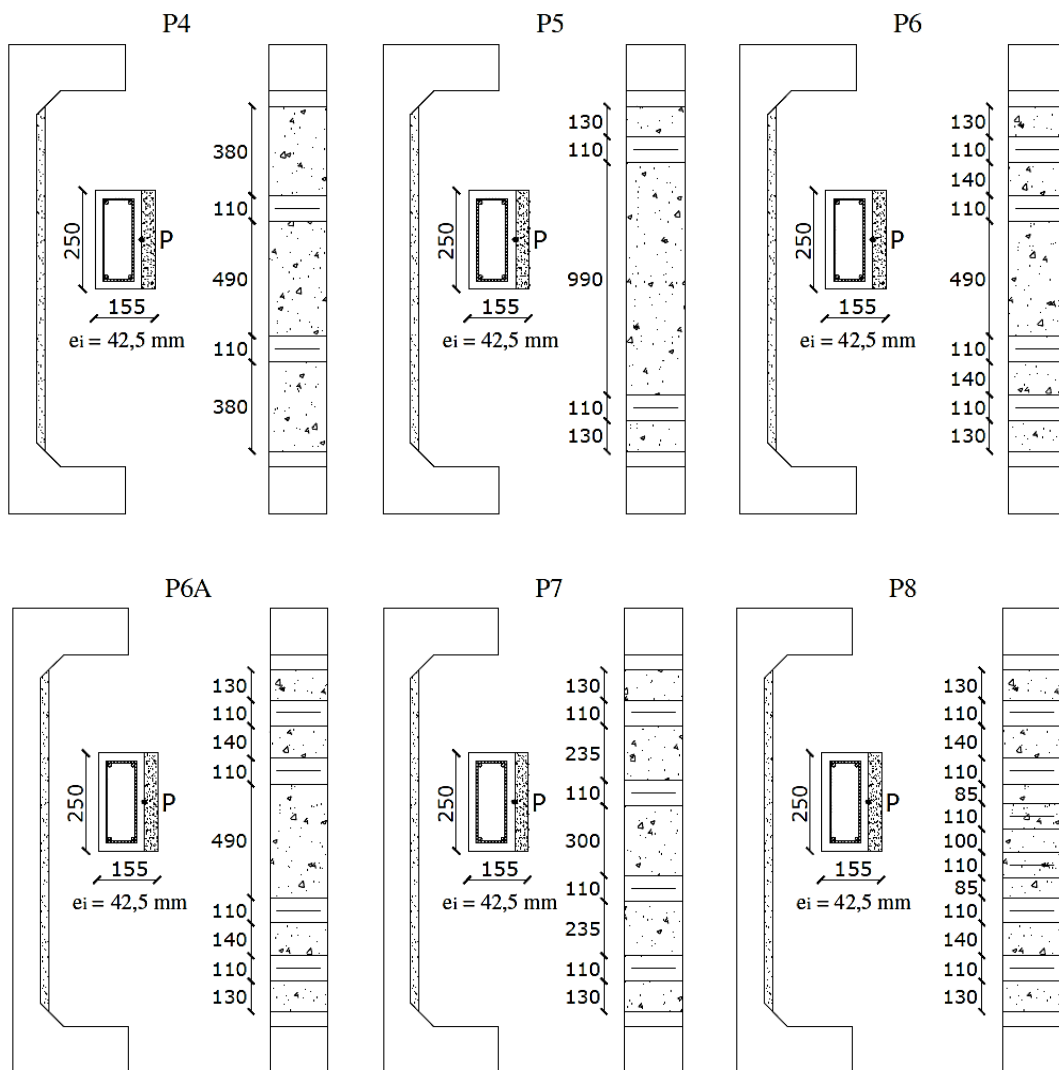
36 - Localização dos estribos conectores na face comprimida dos pilares (mm)
